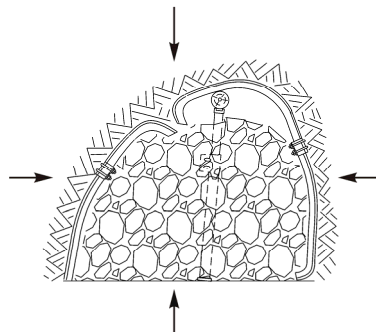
Изменяющаяся нагрузка (уменьшение поперечного сечения на 80–100 %)
